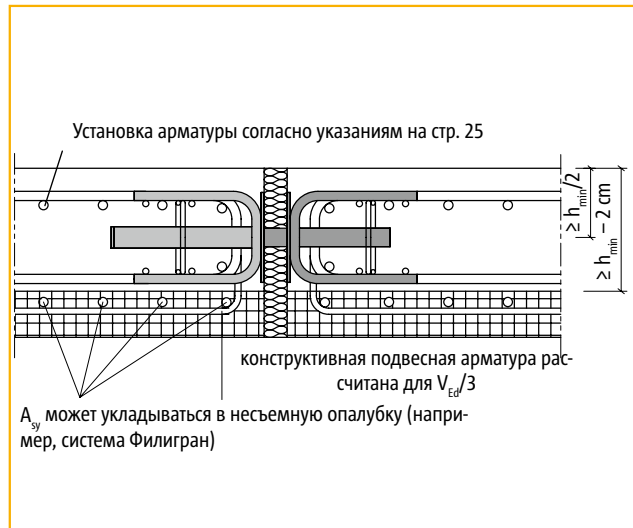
Плита перекрытия с применением несъемной опалубки
